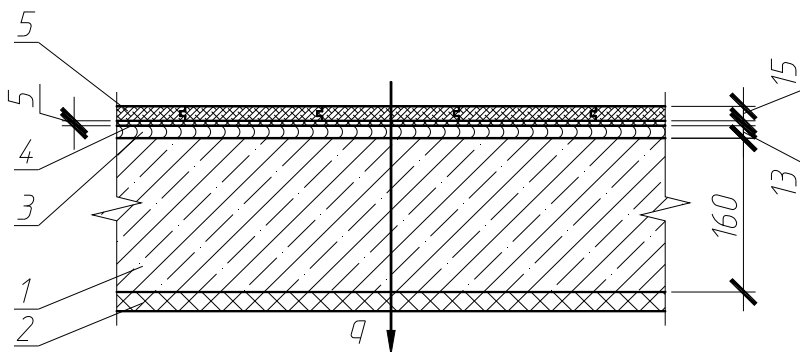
Конструкция перекрытия над техническим подпольем
